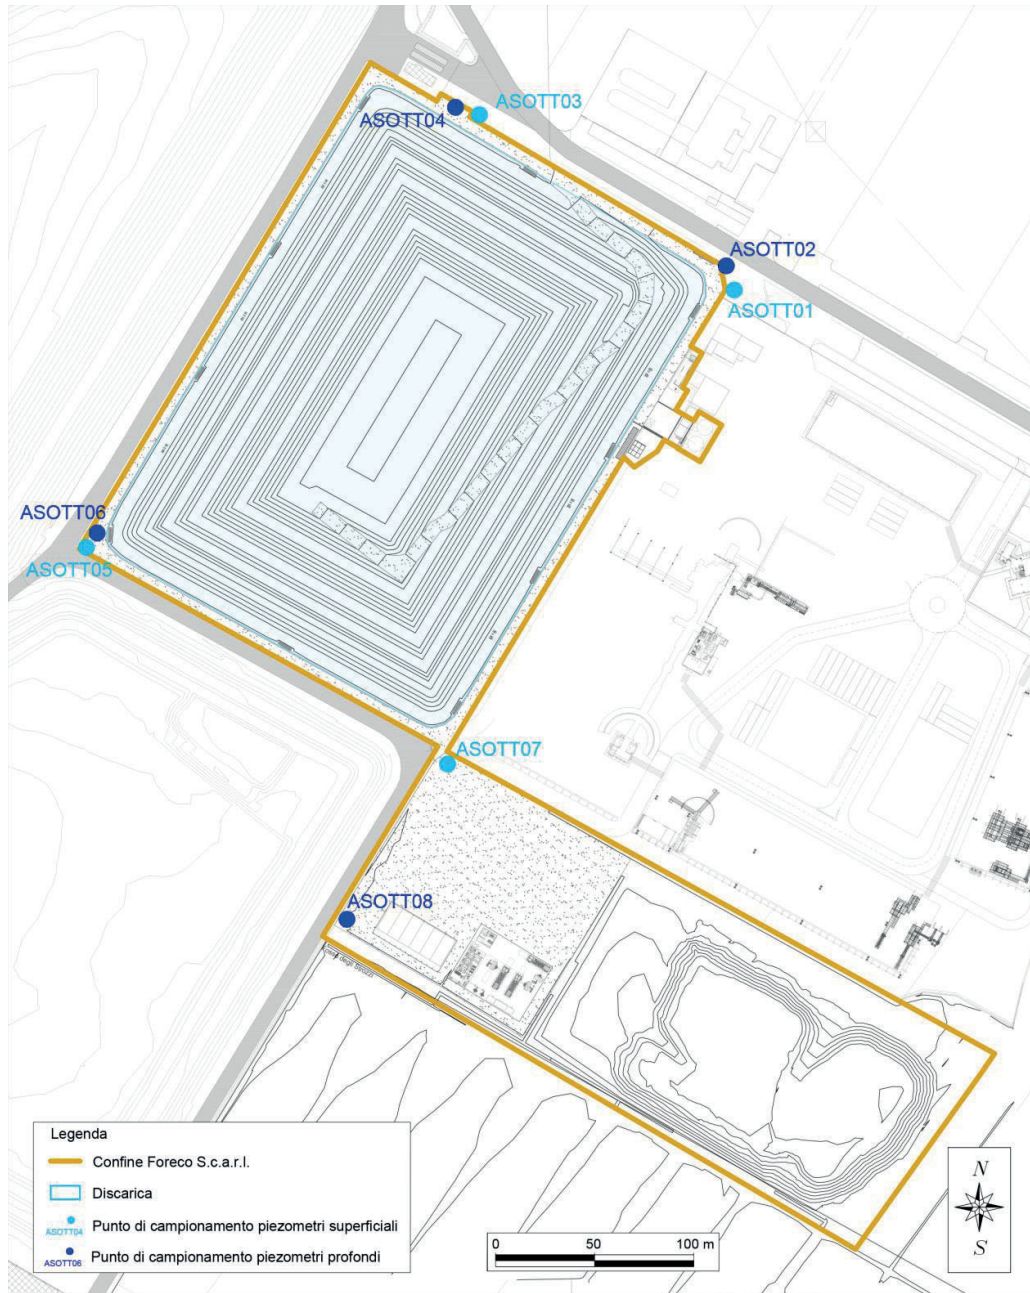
2 – Planimetria con ubicazione piezometri di monitoraggio
